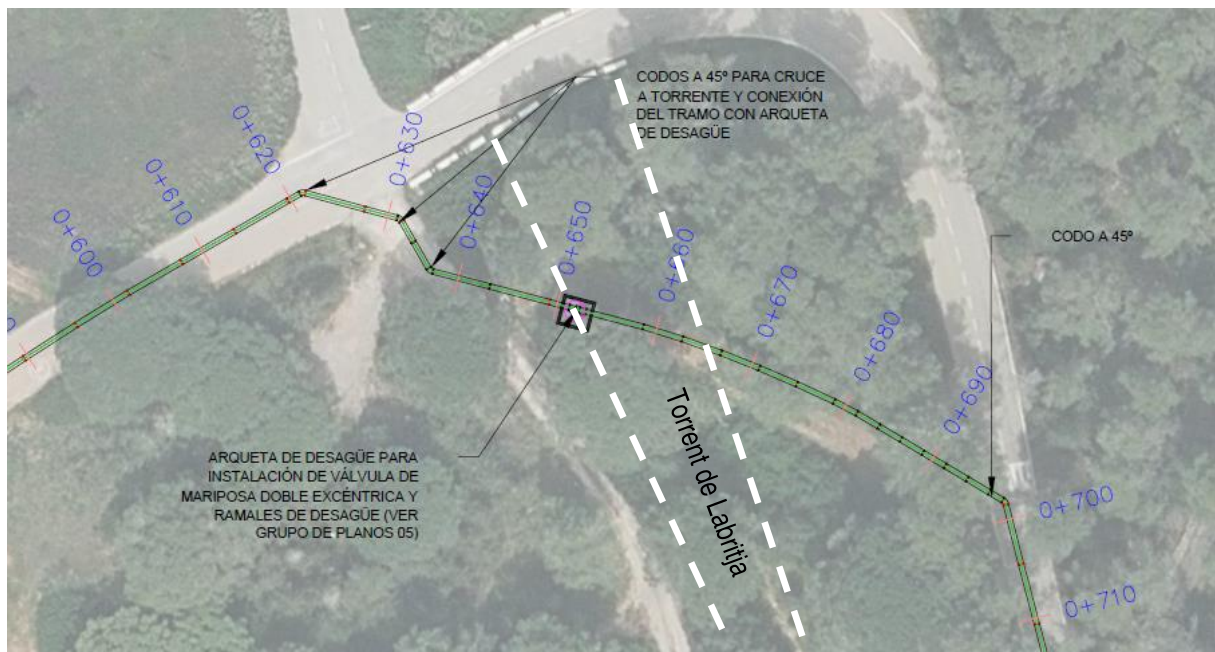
Planta General con el inicio y final del tramo objeto de proyecto. Fuente: Elaboración Propia
